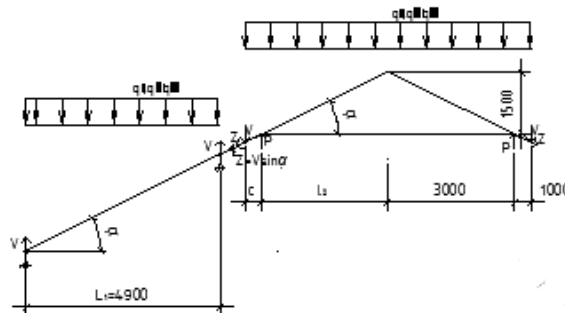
Расчетная схема стропильной ноги и фермы
